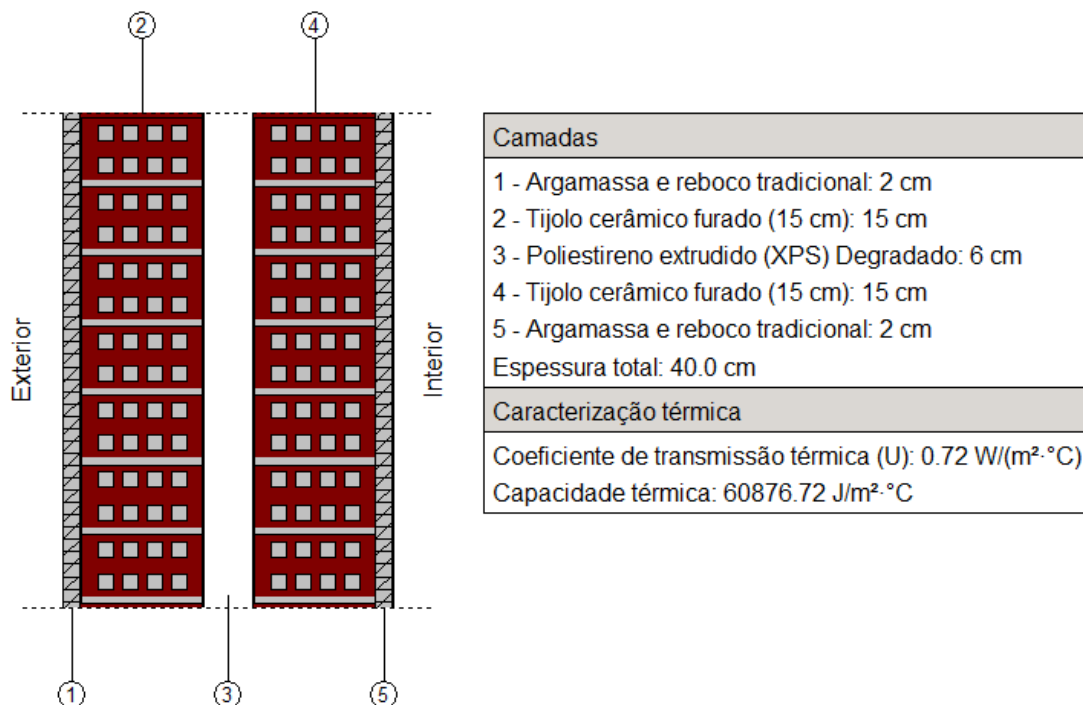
Vista de corte da parede exterior da situação inicial com degradação
